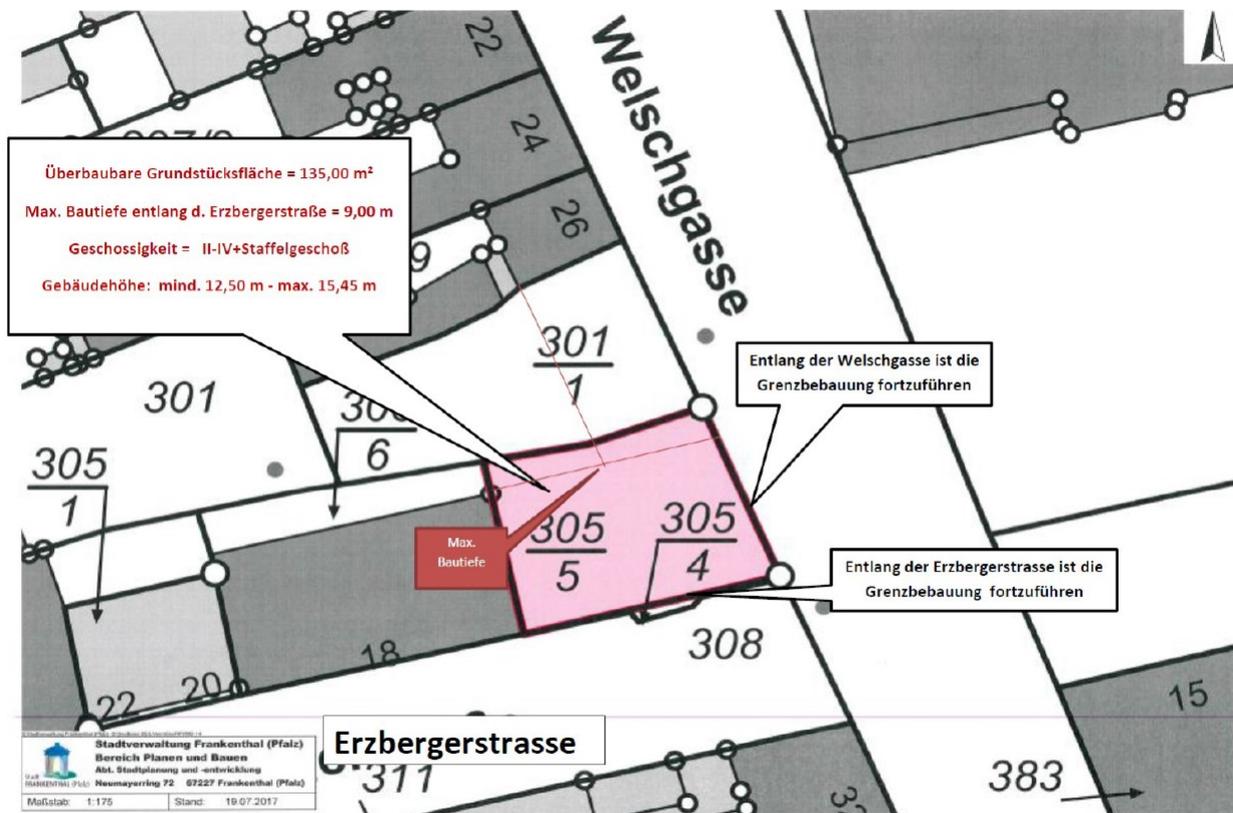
Lageplan mit städtebaulichen Parametern o. M.
